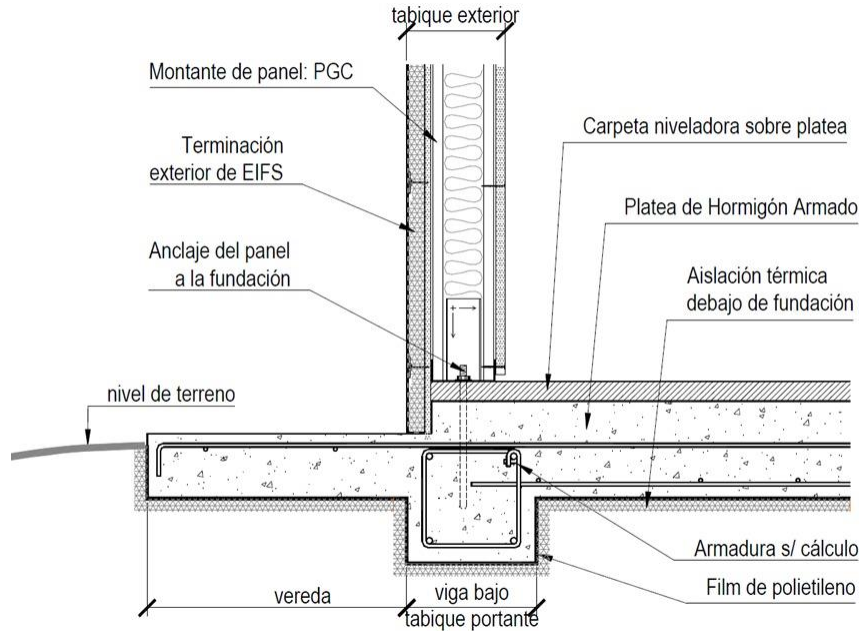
Esquema representativo fundación estructura de Steel Frame
